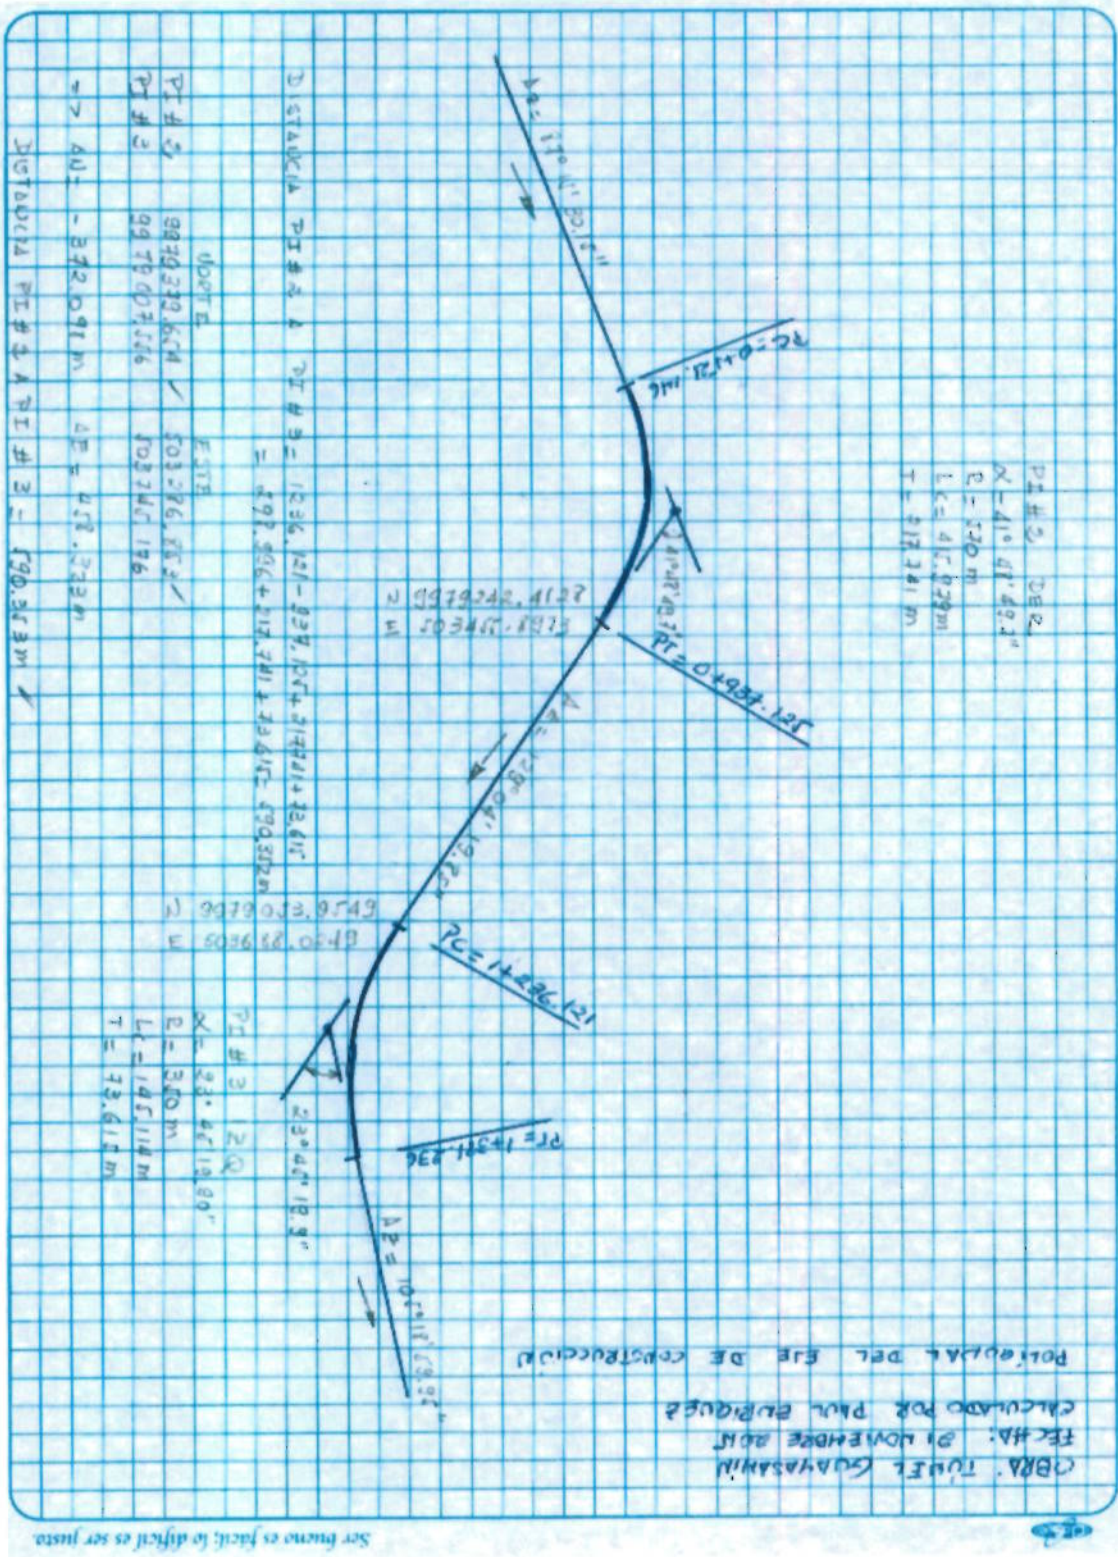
Cálculo completo de la Geometría en Planta para la construcción del Túnel Guayasamin - Sur
